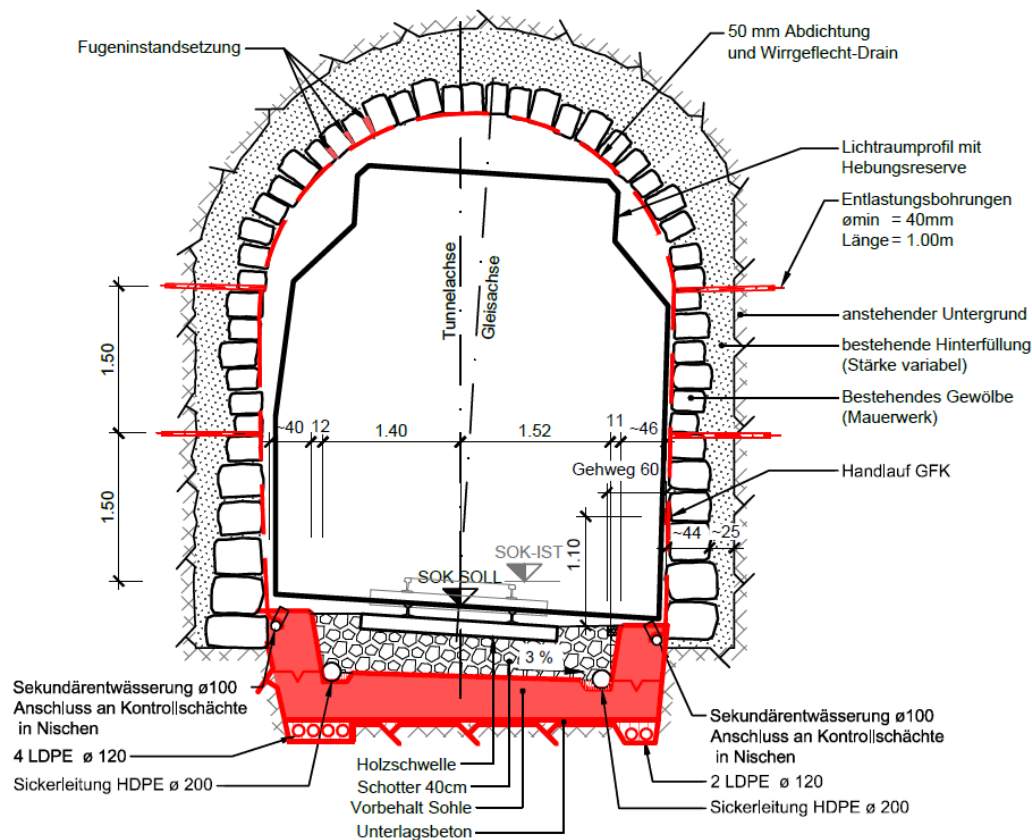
Charnadüratunnel, Normalprofil Instandsetzung (Variante Ortsbetonsohle)
